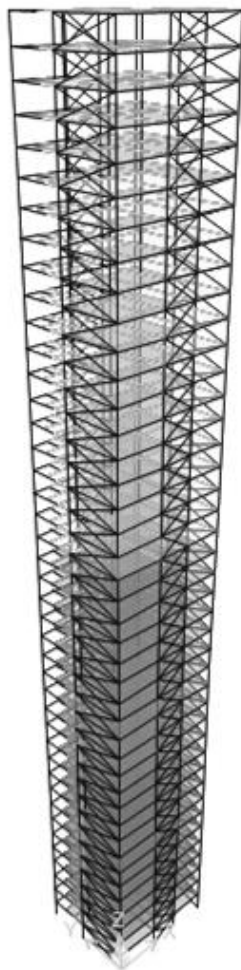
Vista tridimensional do modelo numérico contraventado com treliças
